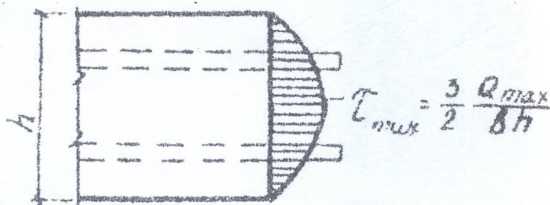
Епюри дотичних напруг у перерізі балки.
